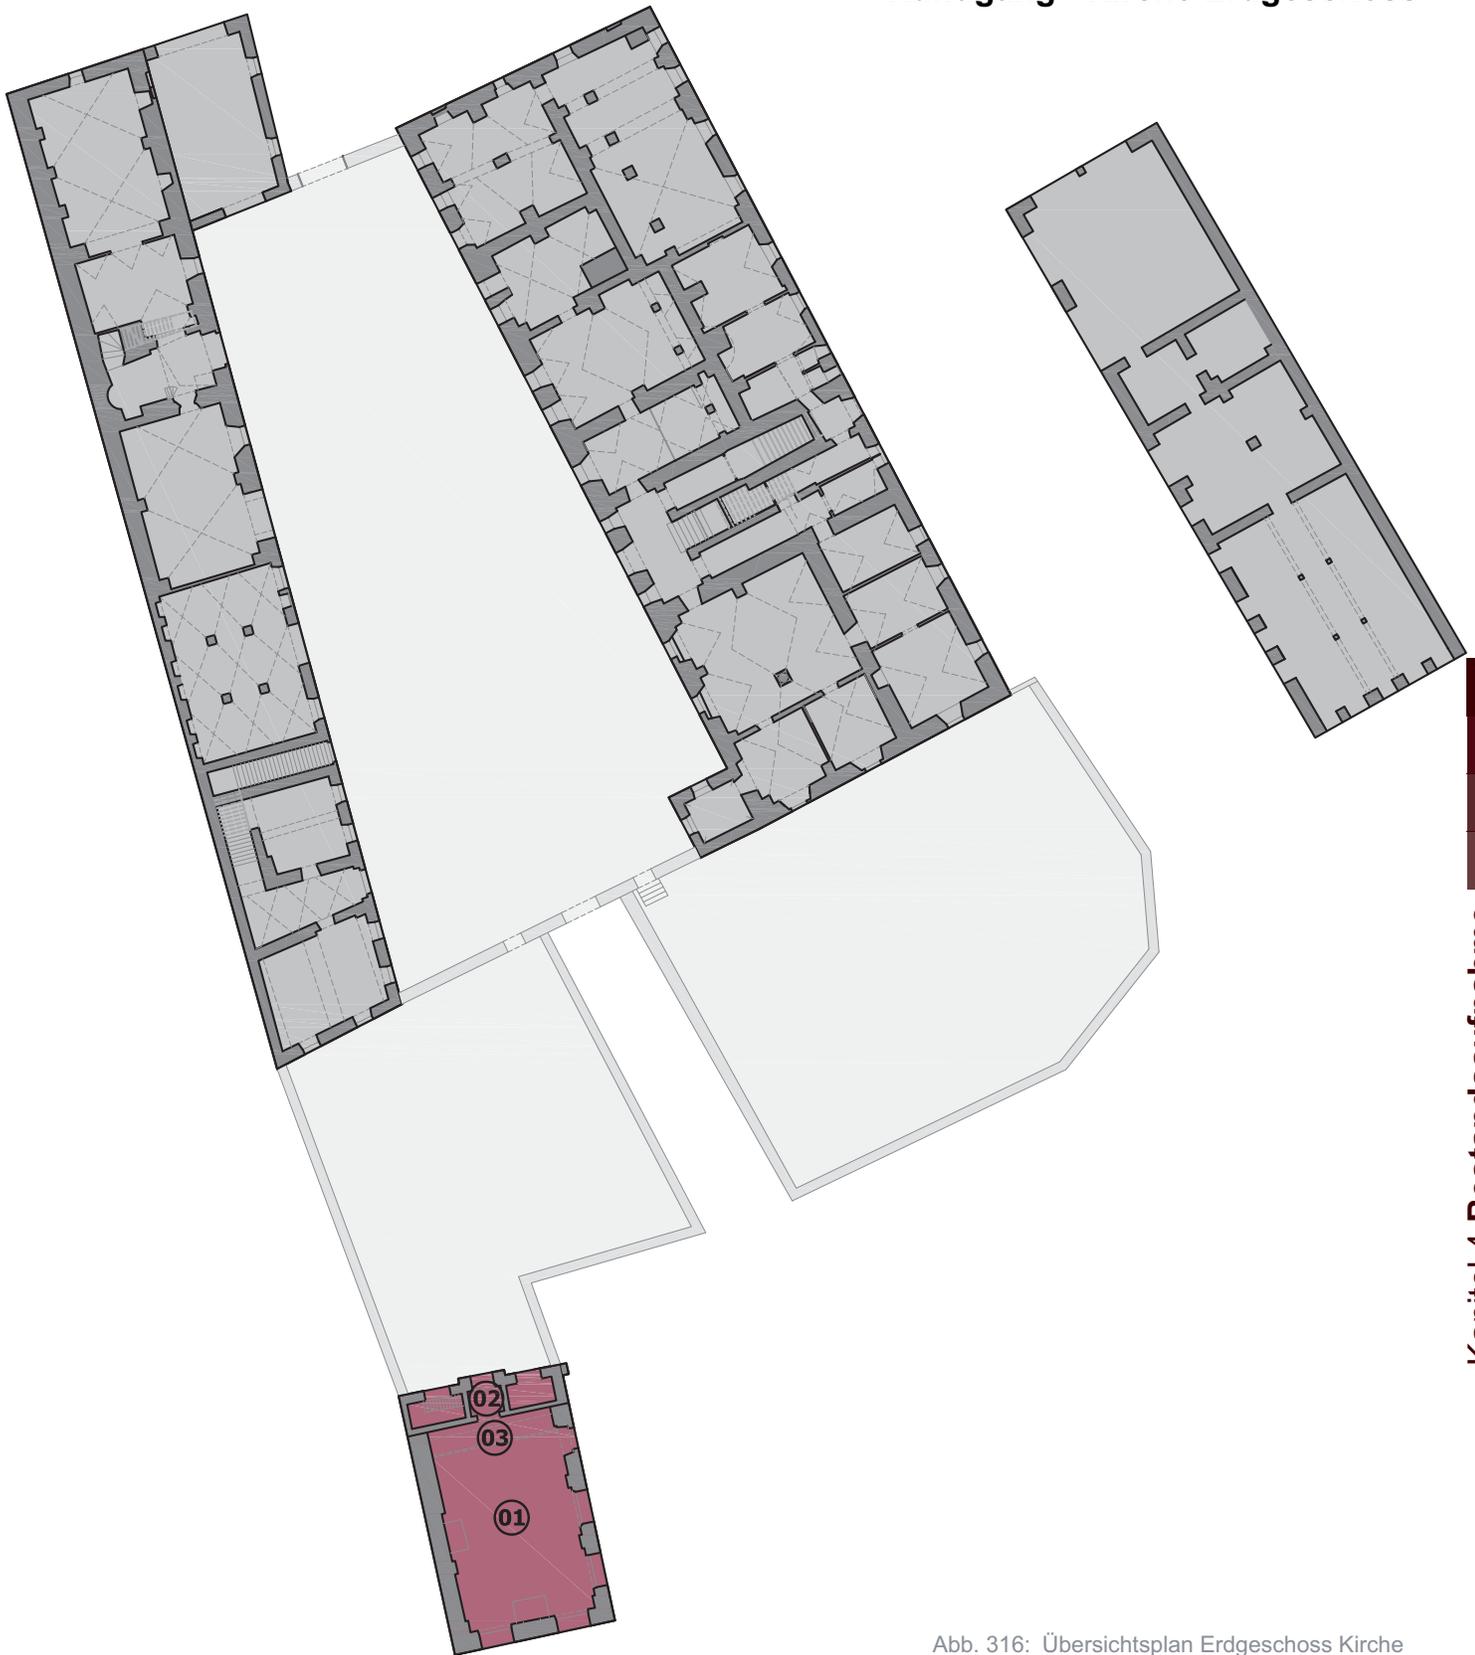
Übersichtsplan Erdgeschoss Kirche
